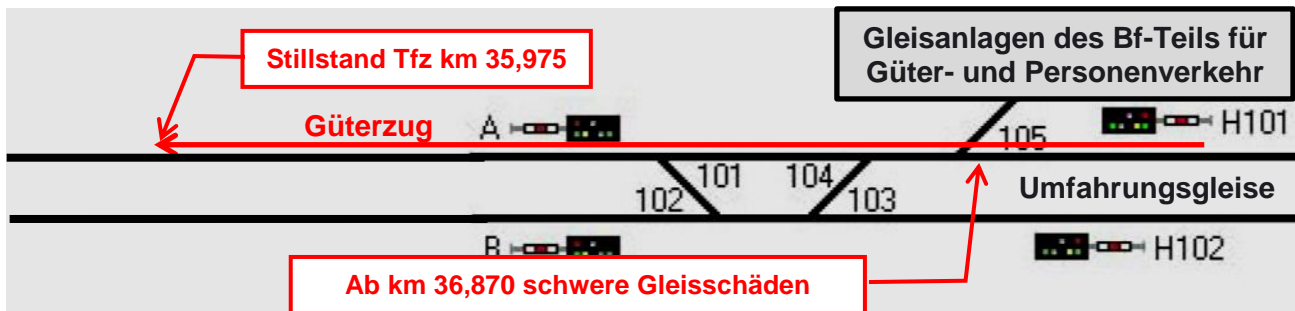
Lageplanskizze Detailauszug IM-Bf (Quelle IM)
